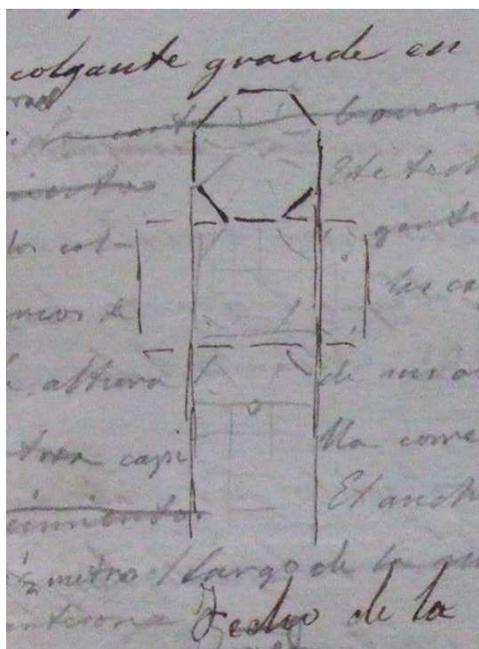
boceto de la distribución de las armaduras realizado por Manuel Gómez-Moreno.
